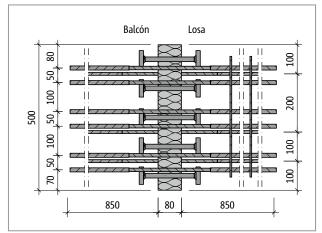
Schöck Isokorb® T tipo K-M12-V1: Plano del producto
